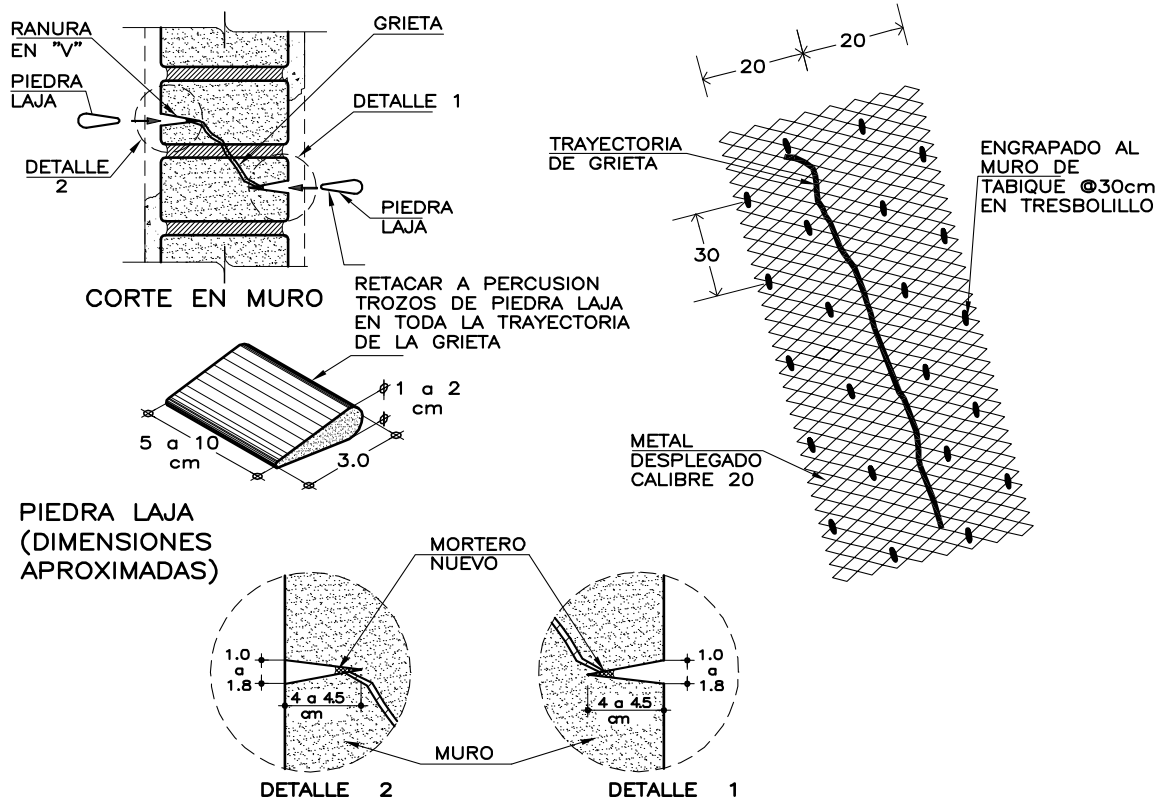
Detalles para reparación de agrietamientos en muros con aplanado.
